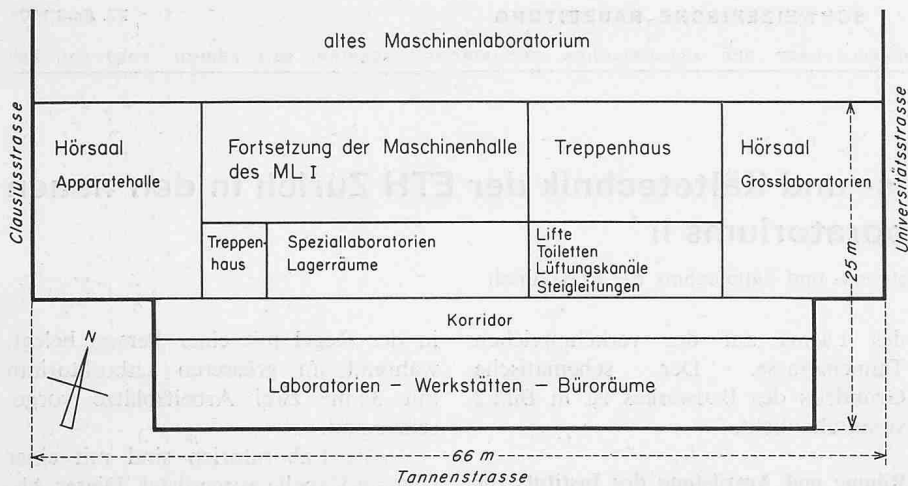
Schematischer Grundriss 1:600 des Bauwerkes
